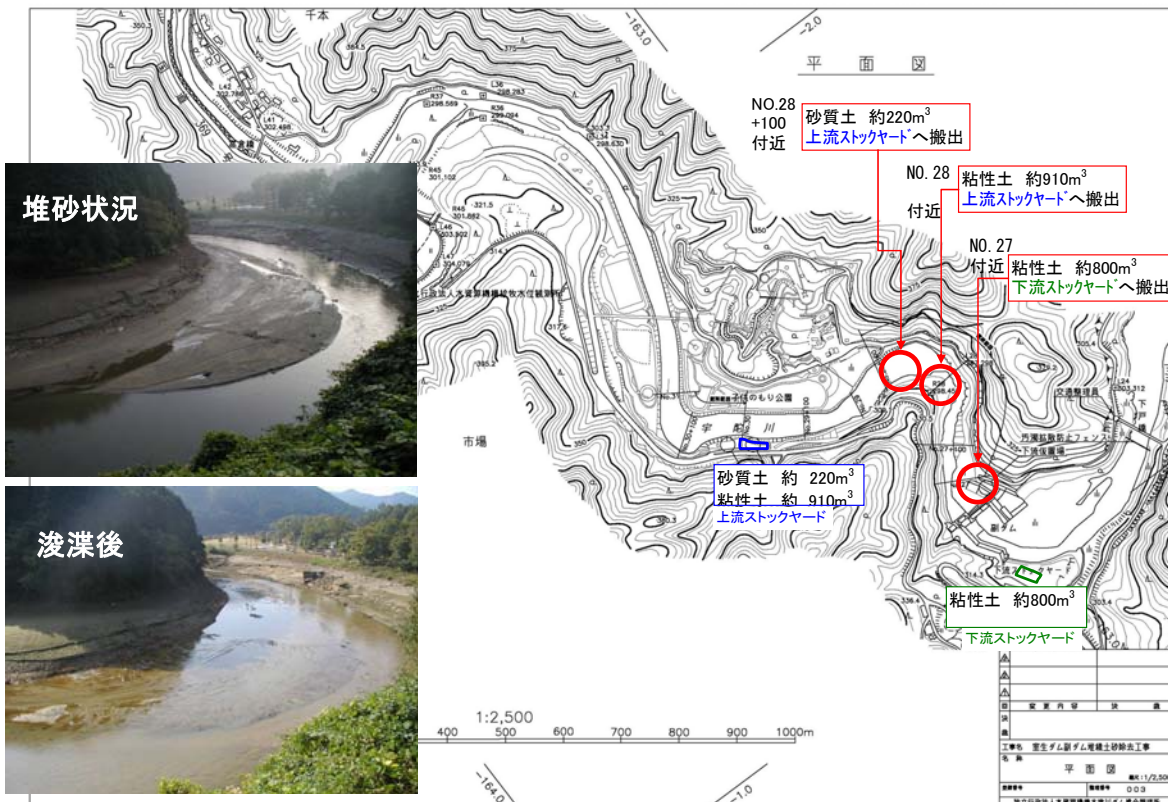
2006(平成18)年度浚渫工事箇所平面図
